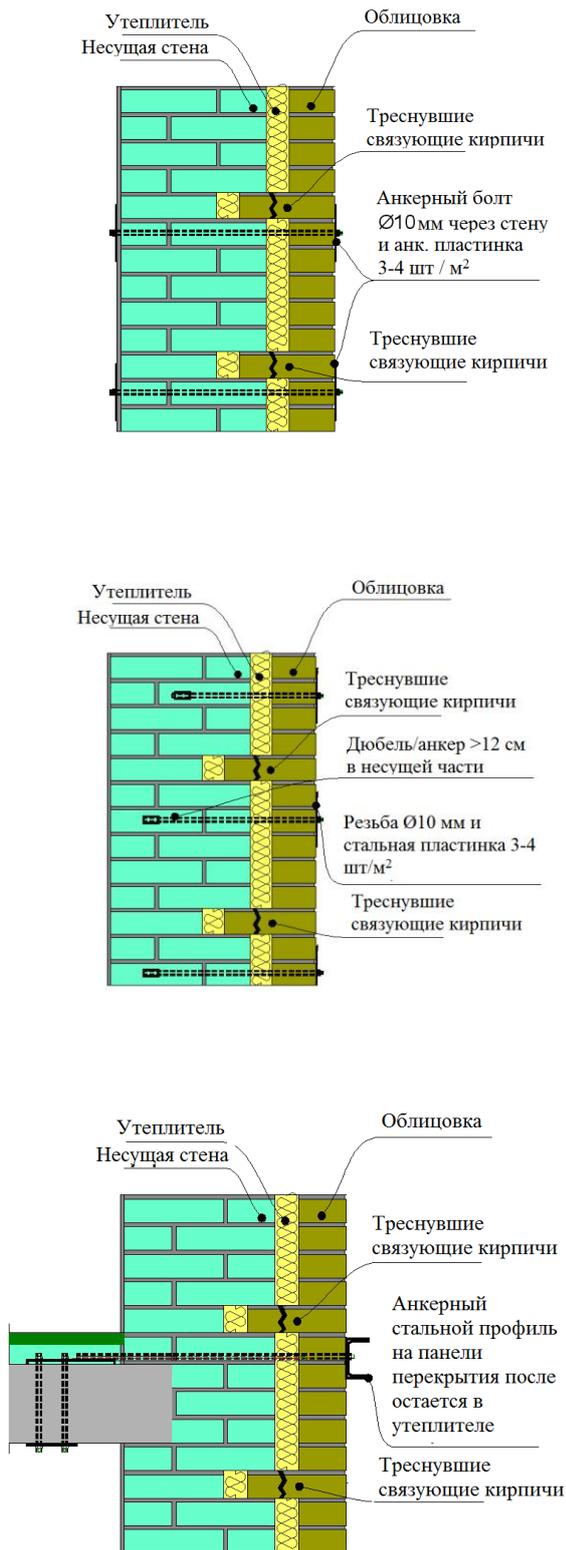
Основные схемы анкеровки кирпичного фасада несущей стены.
